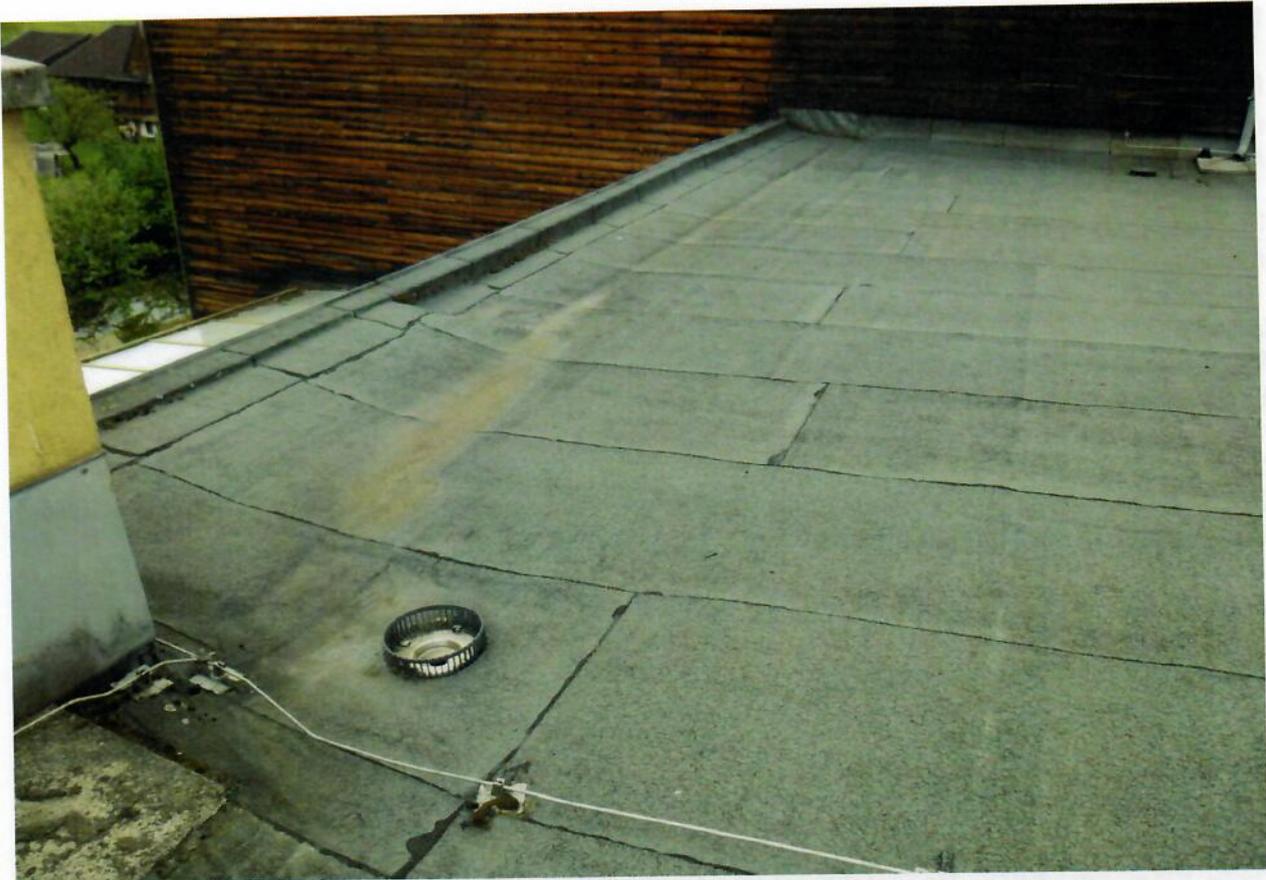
Dach 02: Schadhafte Dachrandanschlüsse, Einläufe
